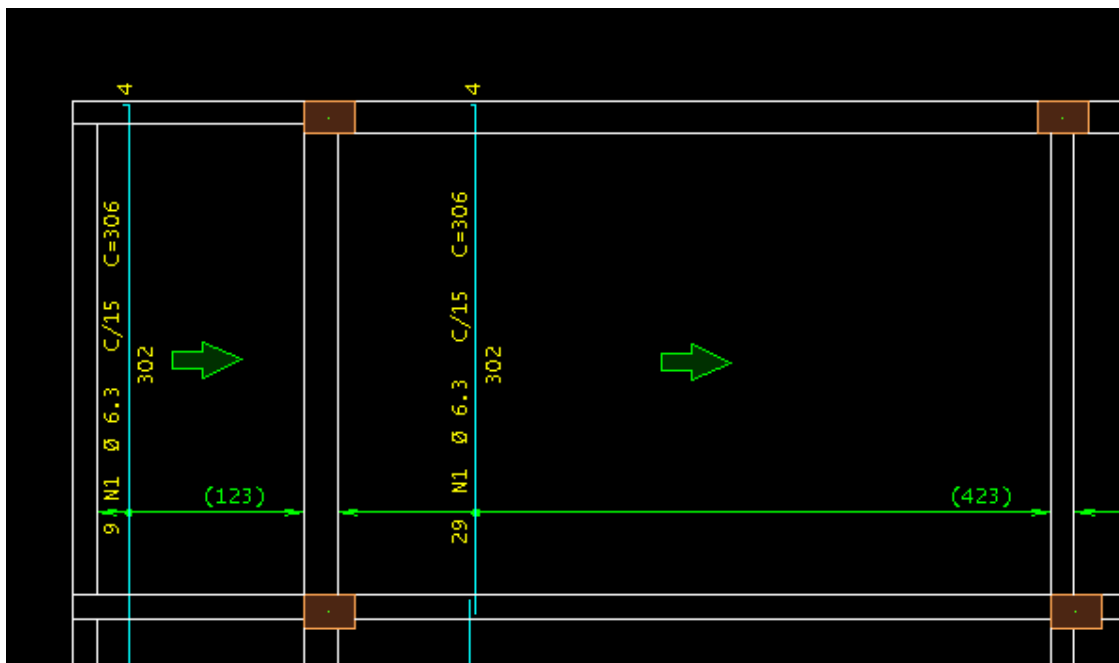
Armadura positiva secundária das lajes L201 e L202
